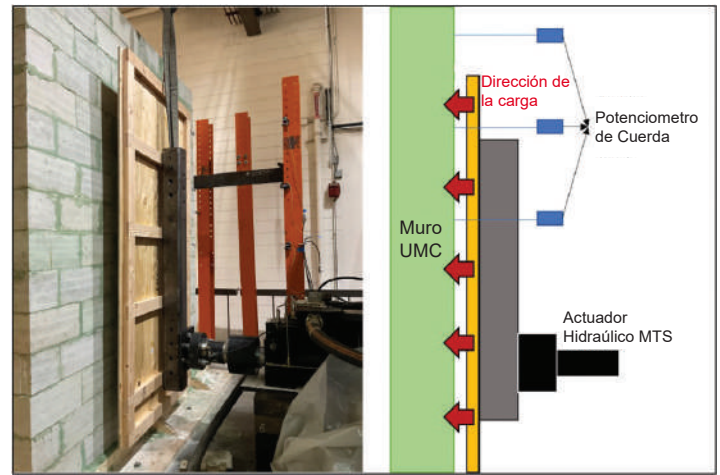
Montaje del ensayo de un muro UMC con una viga de acero y un cajón de madera para aplicar la carga.
